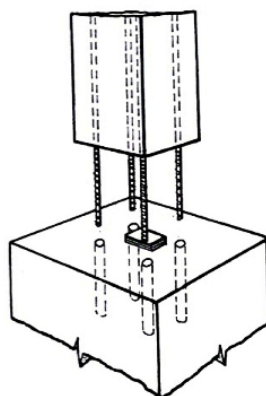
Ligação pilar - fundação com armadura saliente do pilar (extraída de [10])
